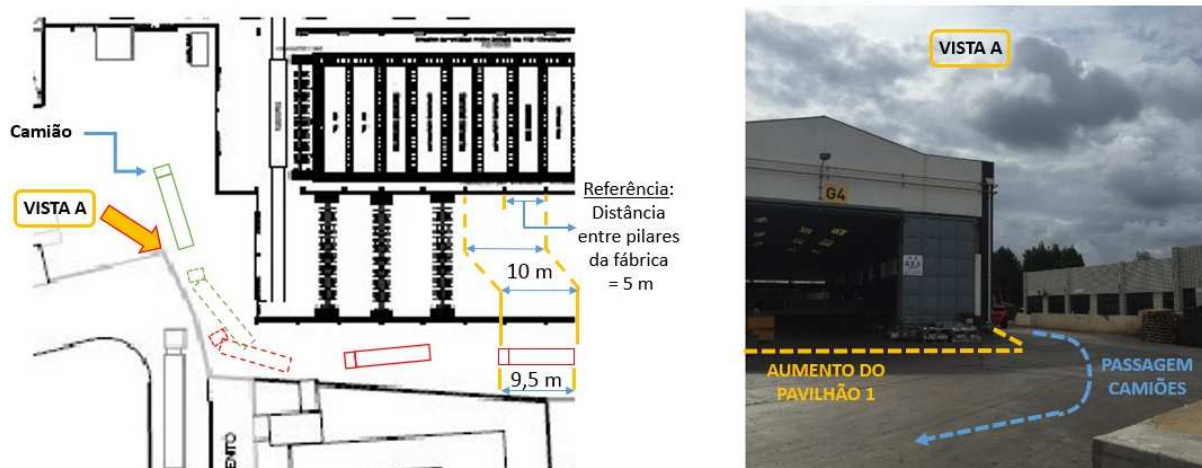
Passagem de camiões na alteração 3 (Aumento do pavilhão 1)
